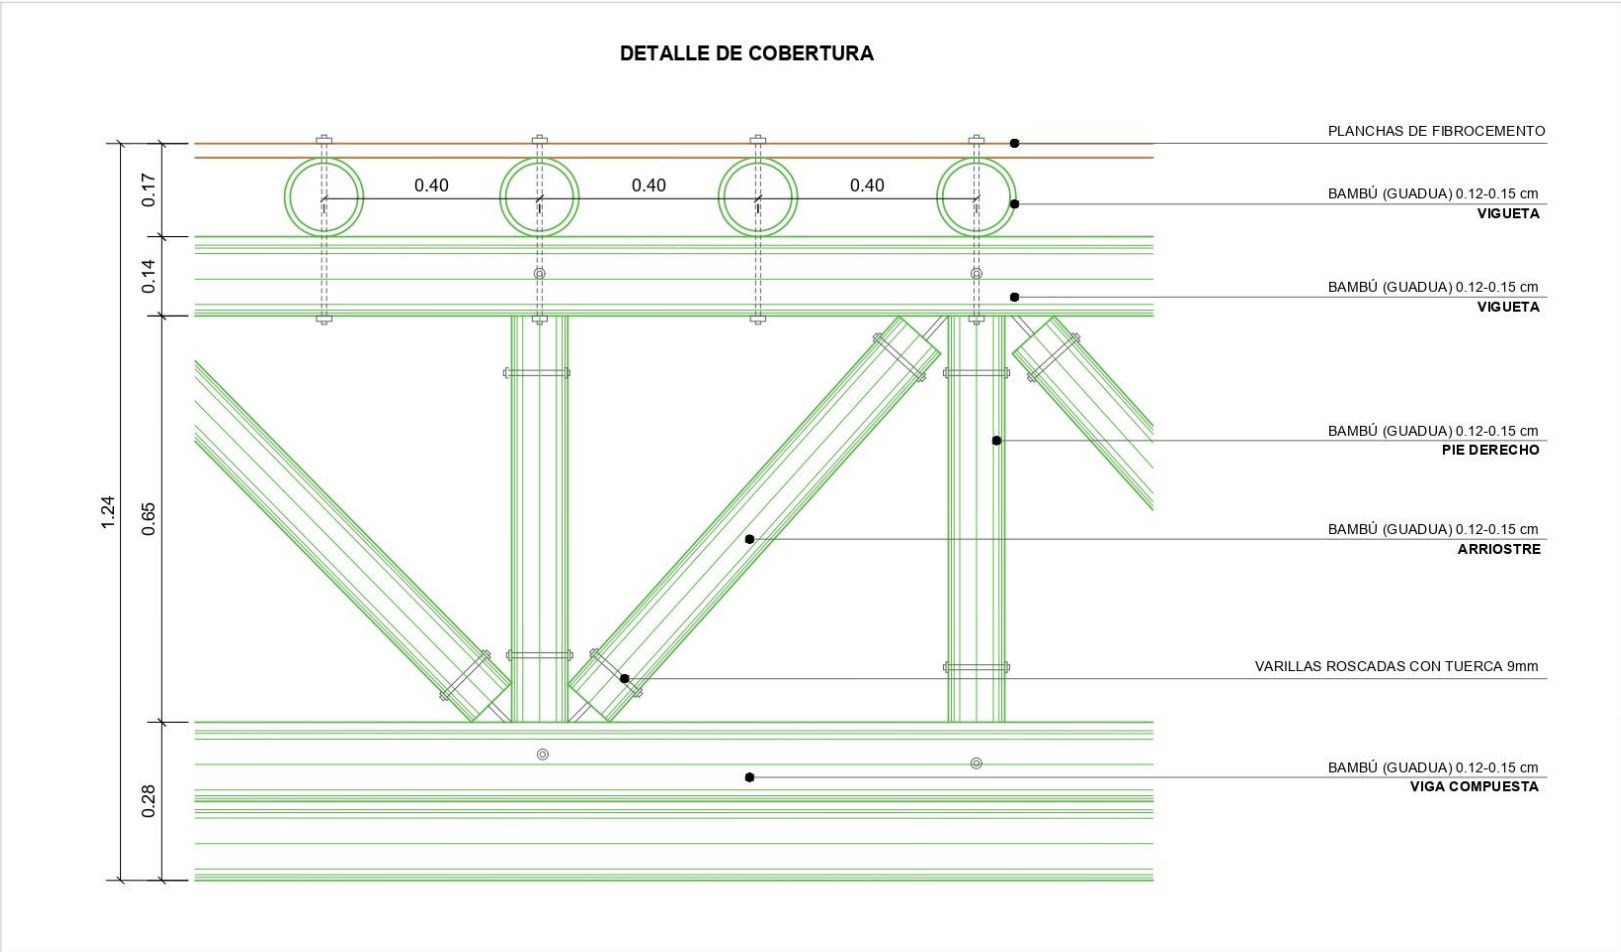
Detalles constructivos de vigas, viguetas y arriostres para el soporte de cobertura. Fuente: El autor
